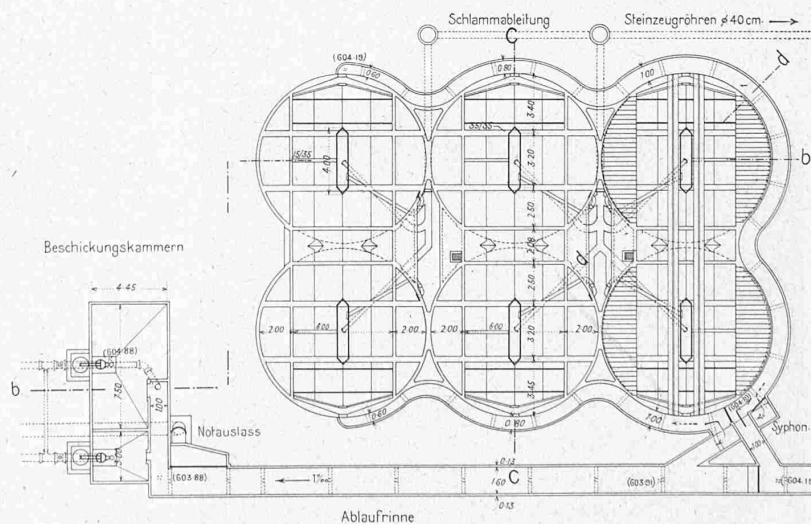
Grundriss der Vor-Reinigungs-Anlage (Emscherbrunnen). — Masstab 1:400.
